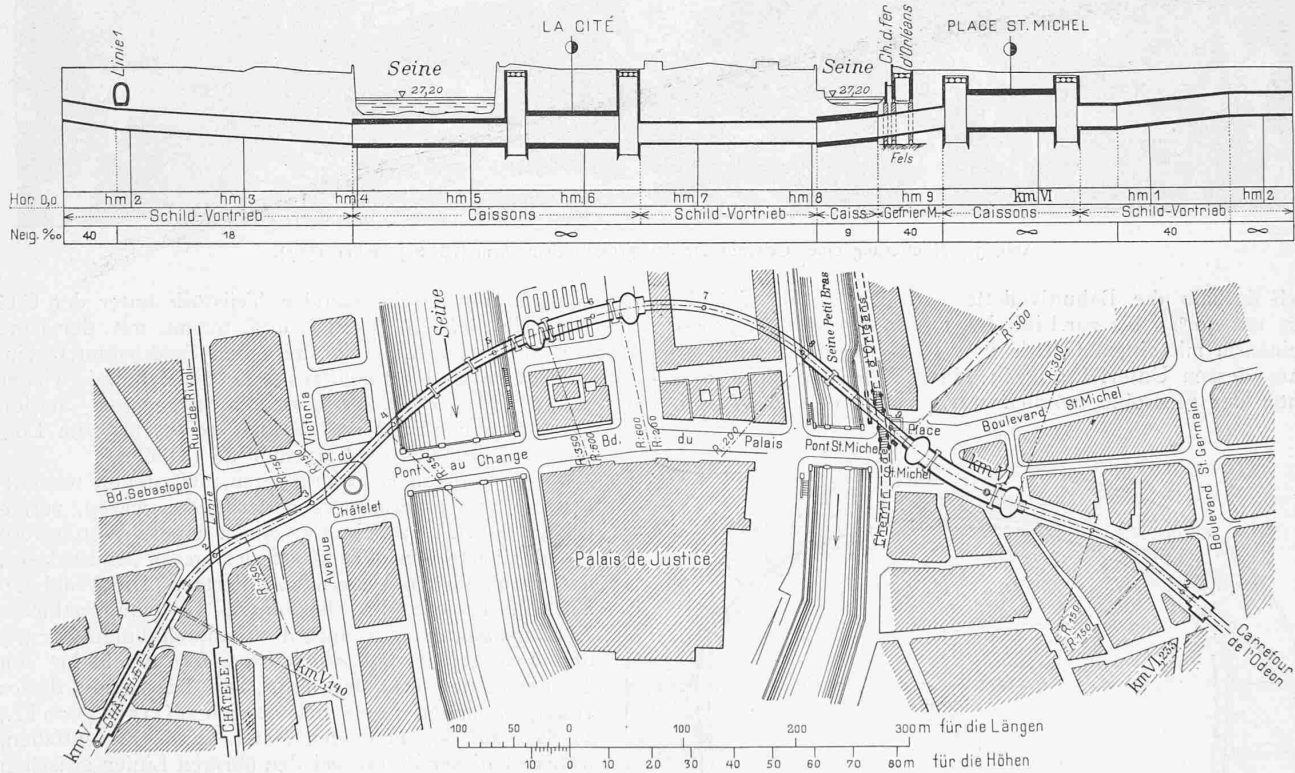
Lageplan und Längenprofil des 7. Bauos der Pariser Stadtbahnlinie Nr. 4. — Masstab: Längen 1 : 6000, Höhen 1 : 1700.
